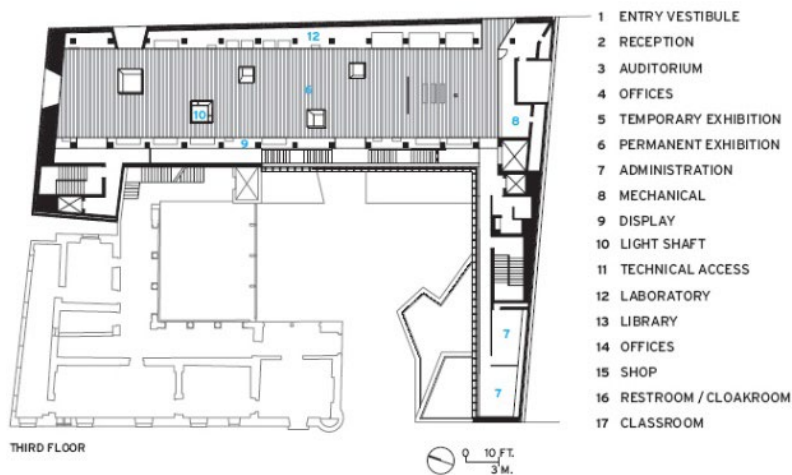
plan de 3ème étage du musée d'Alava (archdaily.com).
